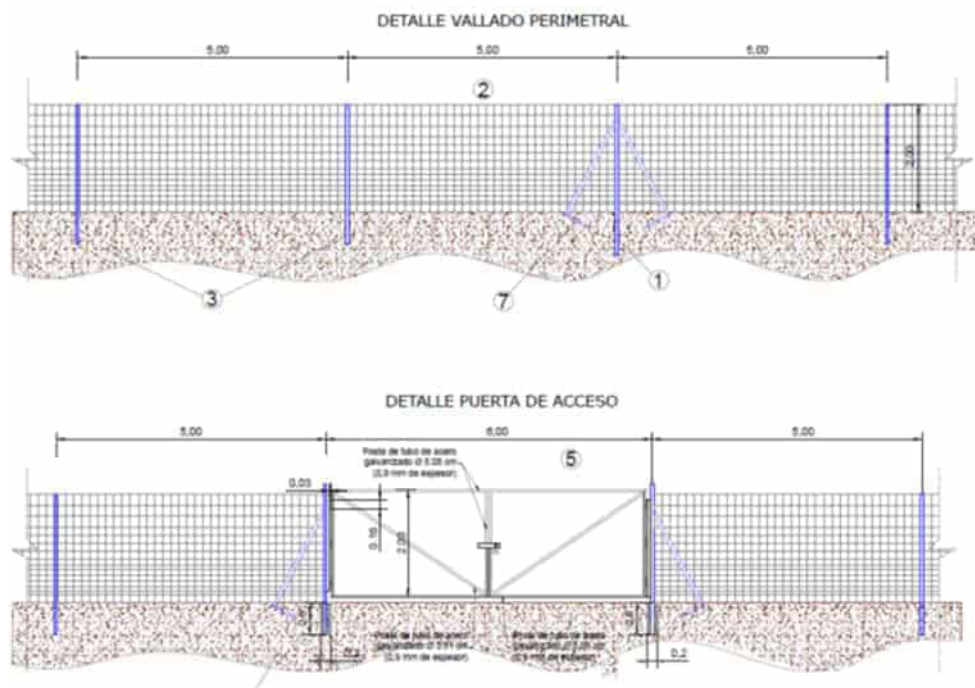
Detalle del vallado perimetral y de la puerta de acceso.
